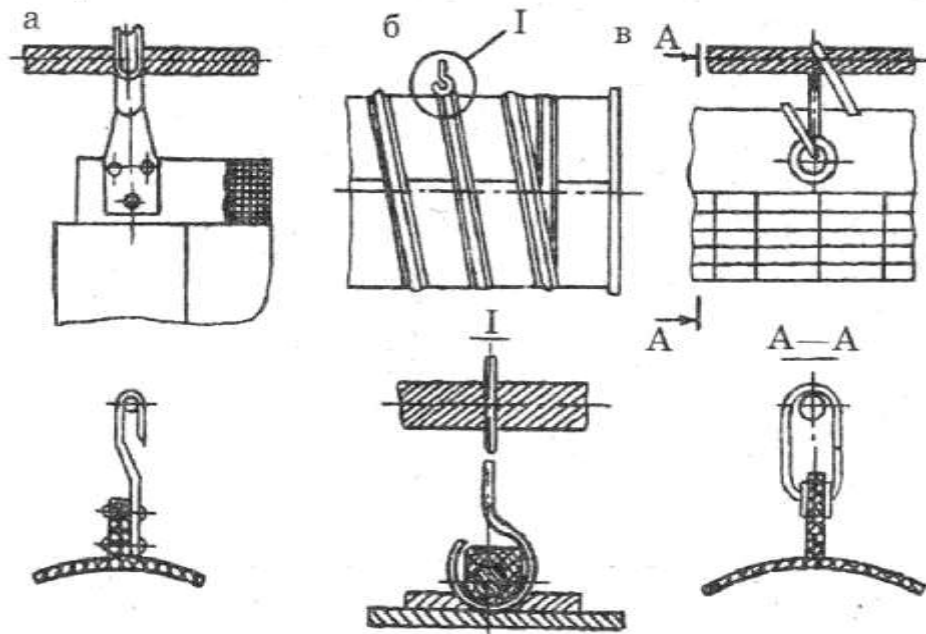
Примерные схемы заземления металлических деталей гибких вентиляционных труб:
